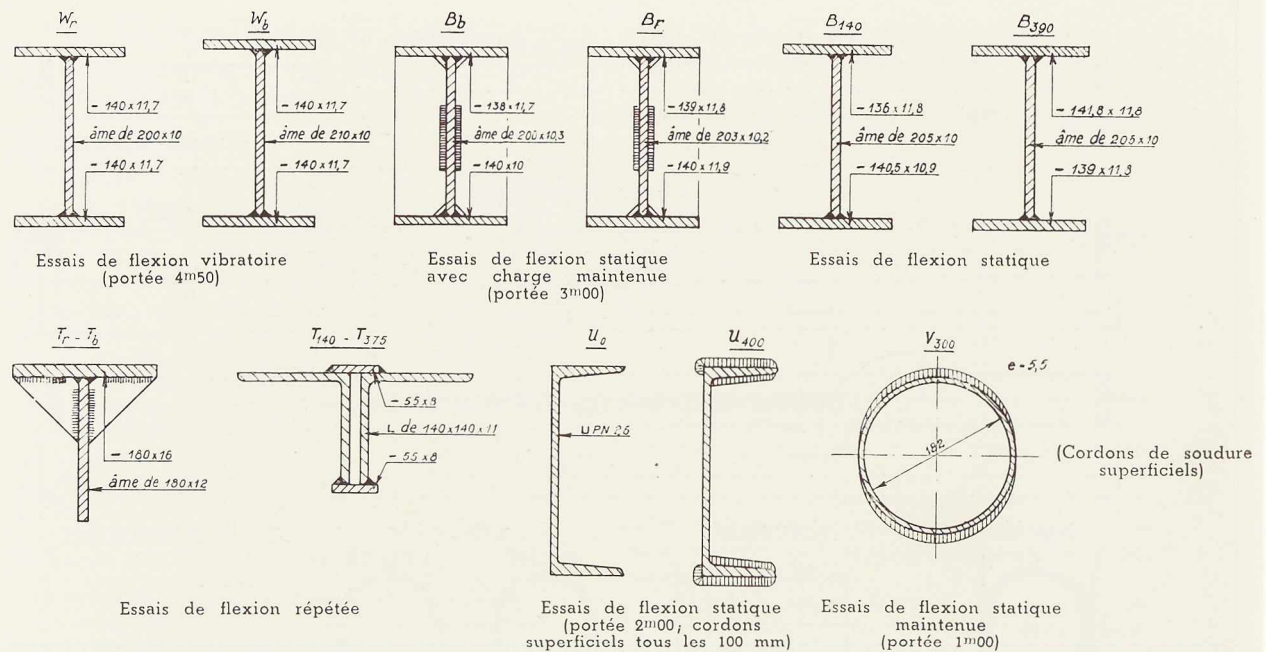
Essais sur poutres fléchies. Schémas des pièces.
